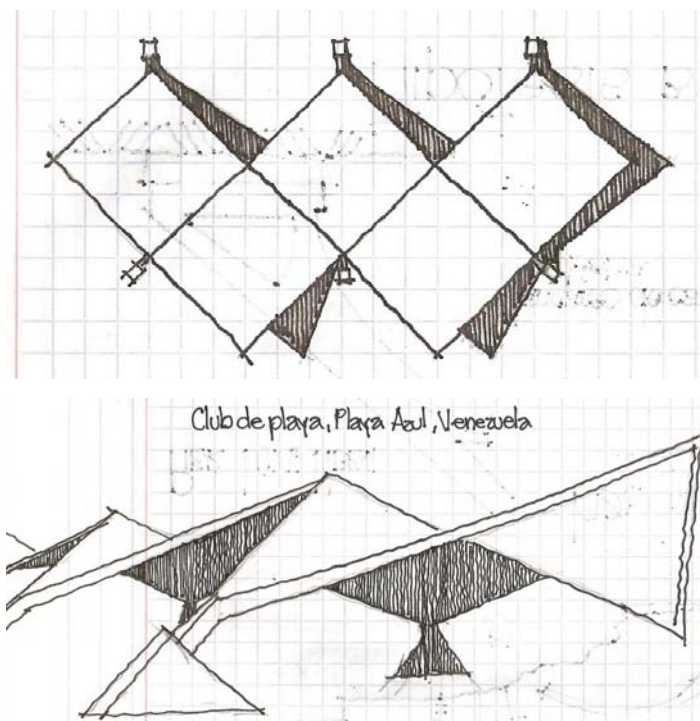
Croquis de la planta de conjunto y alzado, los apoyos son una pequeñez en comparación con el espacio cubierto.
